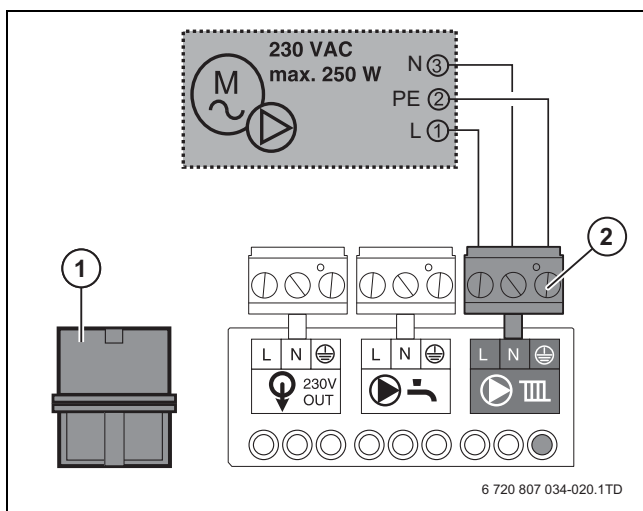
Anschluss des Anschluss-Sets der Pumpe
